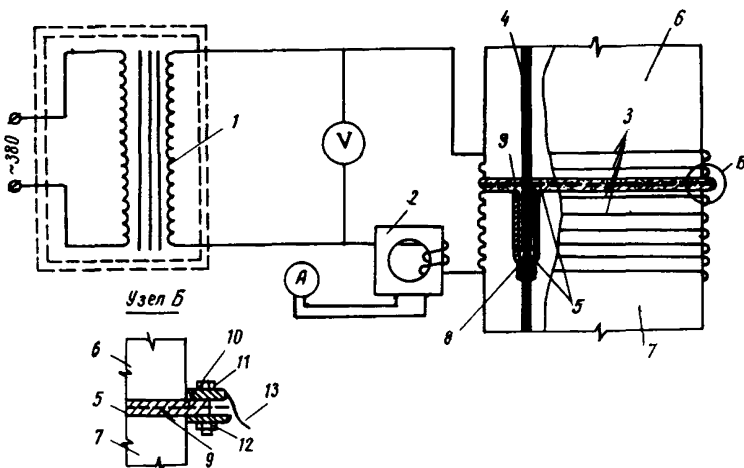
Схема комбинированного электропрогрева клевого стыка с анкеровкой выпусков арматуры в гнездах
